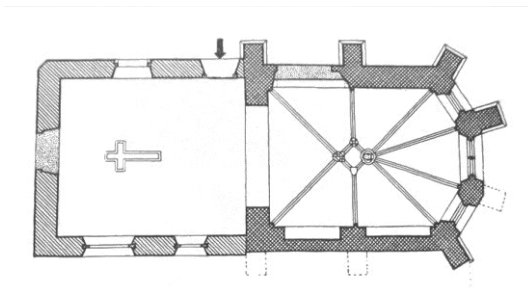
Eller, Rochuskapelle, Grundriss
